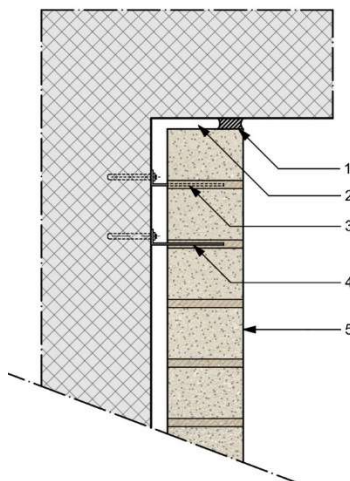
Détail en coupe de la jonction avec chape flottante
